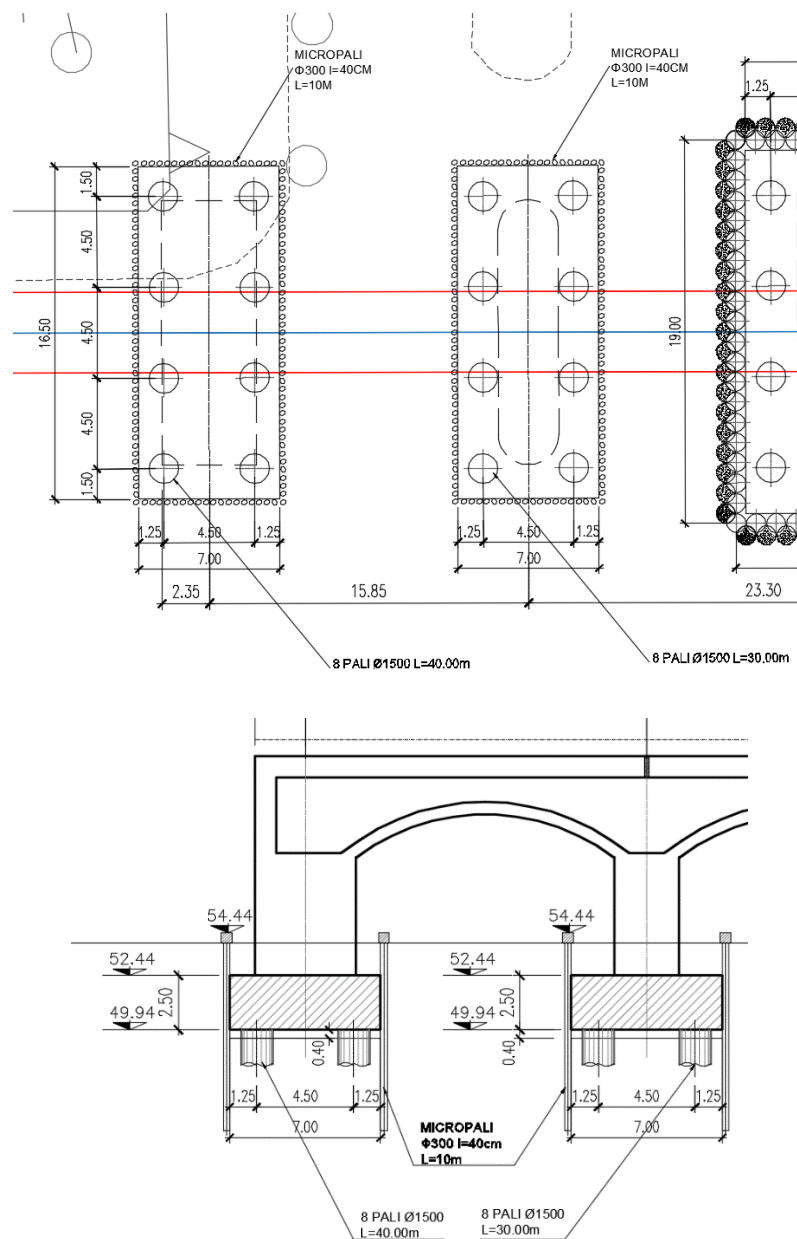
Pianta e prospetto Pila-spalla (Venezia)
